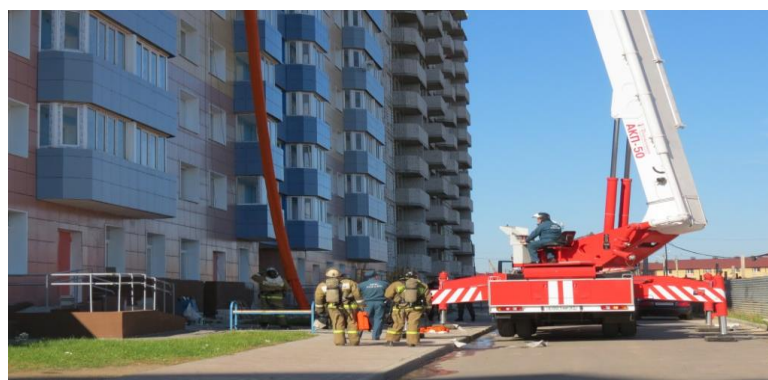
Расстояние от внутреннего края проезда до стены здания
